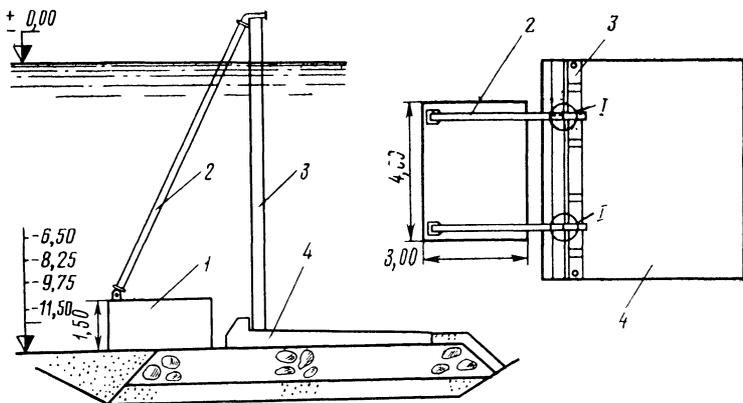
Этап монтажа набережной с внешним анкером:
